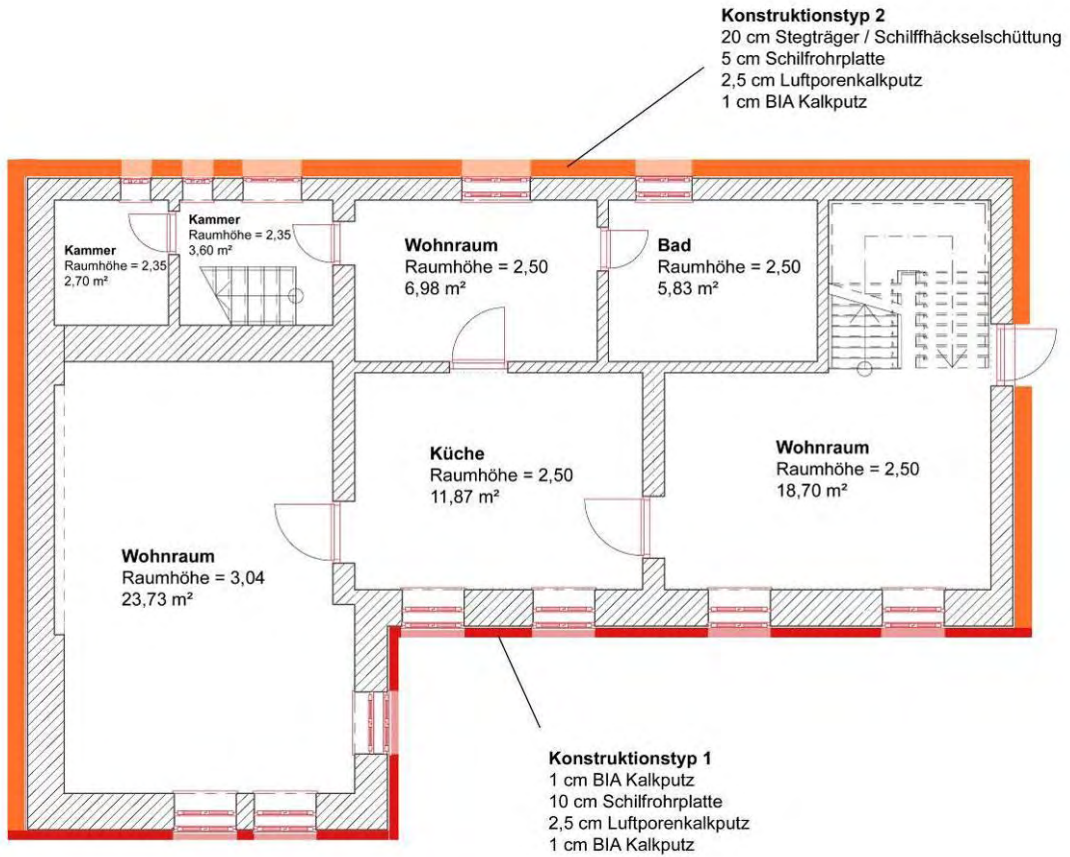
Grundrisschema EG für Sanierungsvariante „Außendämmung“
